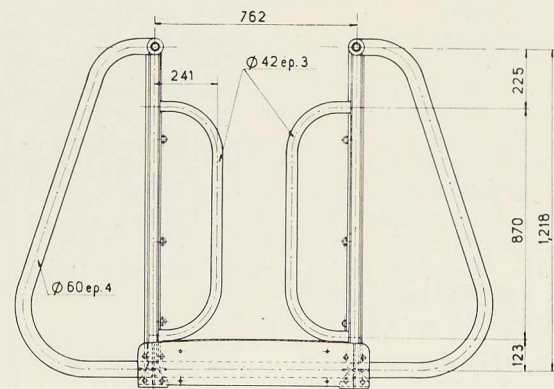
Détail du panneau d'about d'une passerelle tubulaire.
